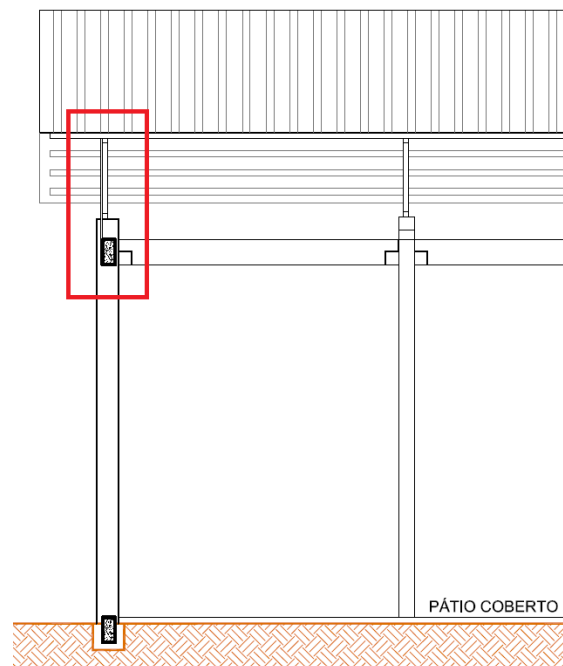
Detalhe da fachada em que o fechamento metálico termina na viga
